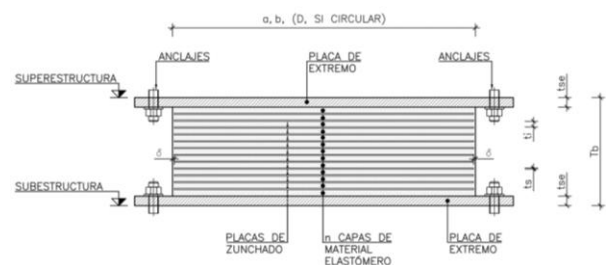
Alzado tipo de un aislador LDRB con anclaje normalizado con vulcanizado de las placas de anclaje
